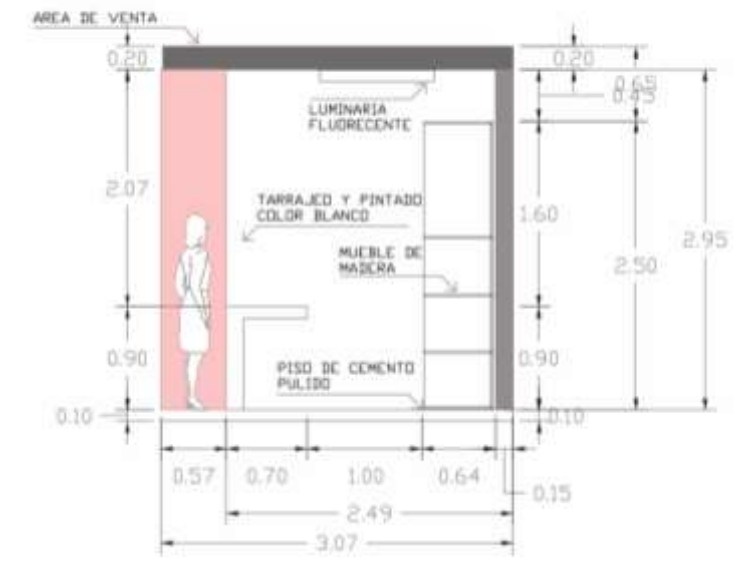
Corte Detallado de Puesto de Confitería / Elaboración propia
